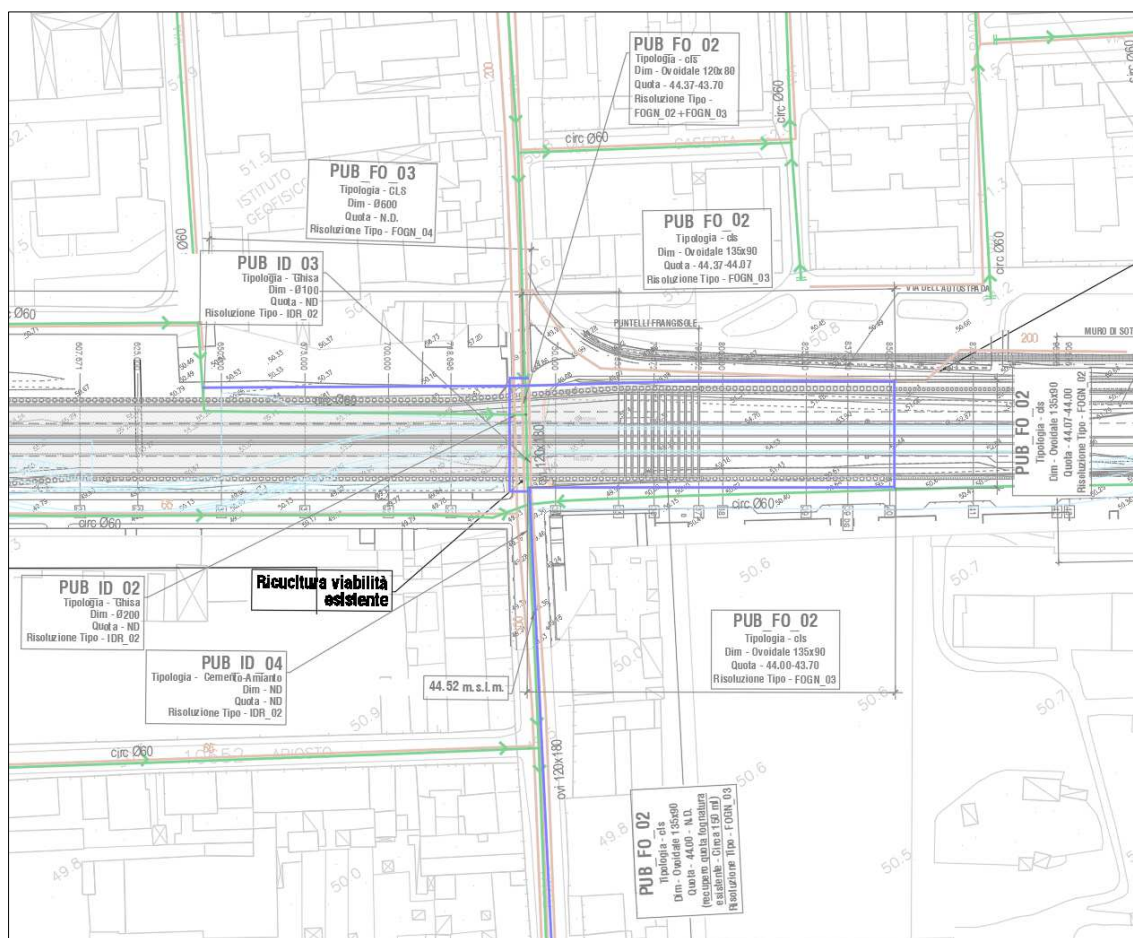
Risoluzione interferenza Via Roma – Planimetria
